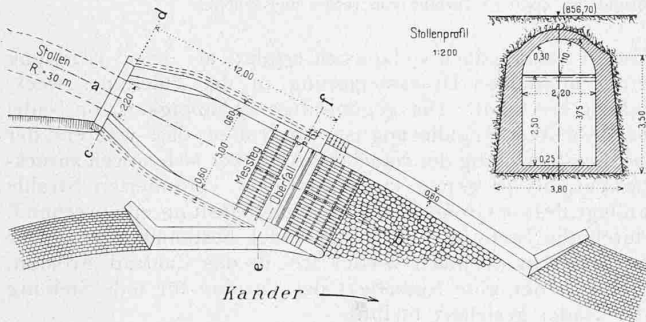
Grundriss des Auslaufs mit Messüberfall; Masstab 1 : 400.
